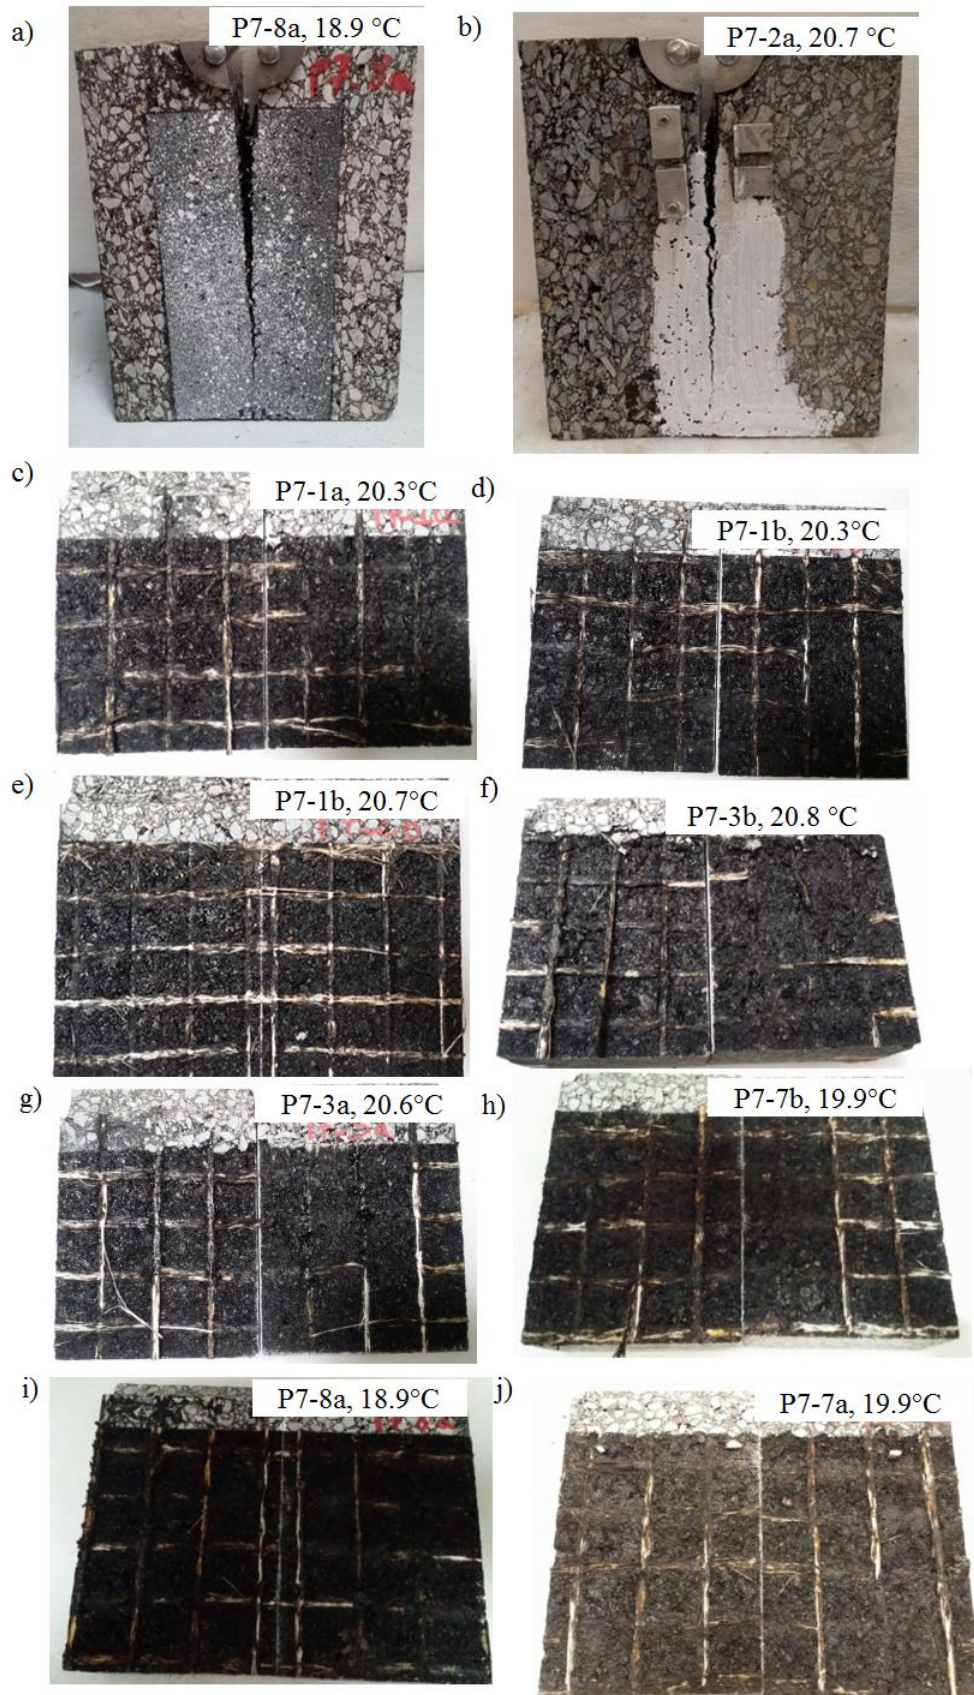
Etat des surfaces de ruptures des interfaces des éprouvettes P7 renforcées avec la grille G4
